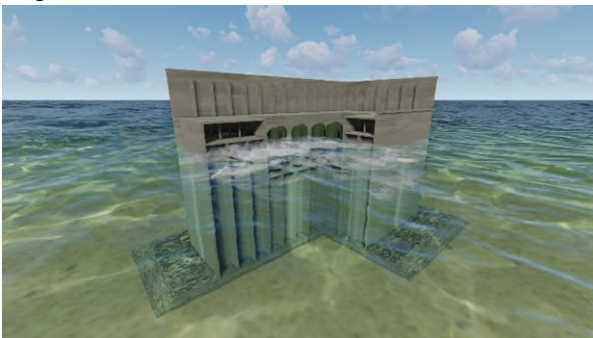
Infografía seccionada del GBS aislado para una planta tipo *offshore small scale*.
